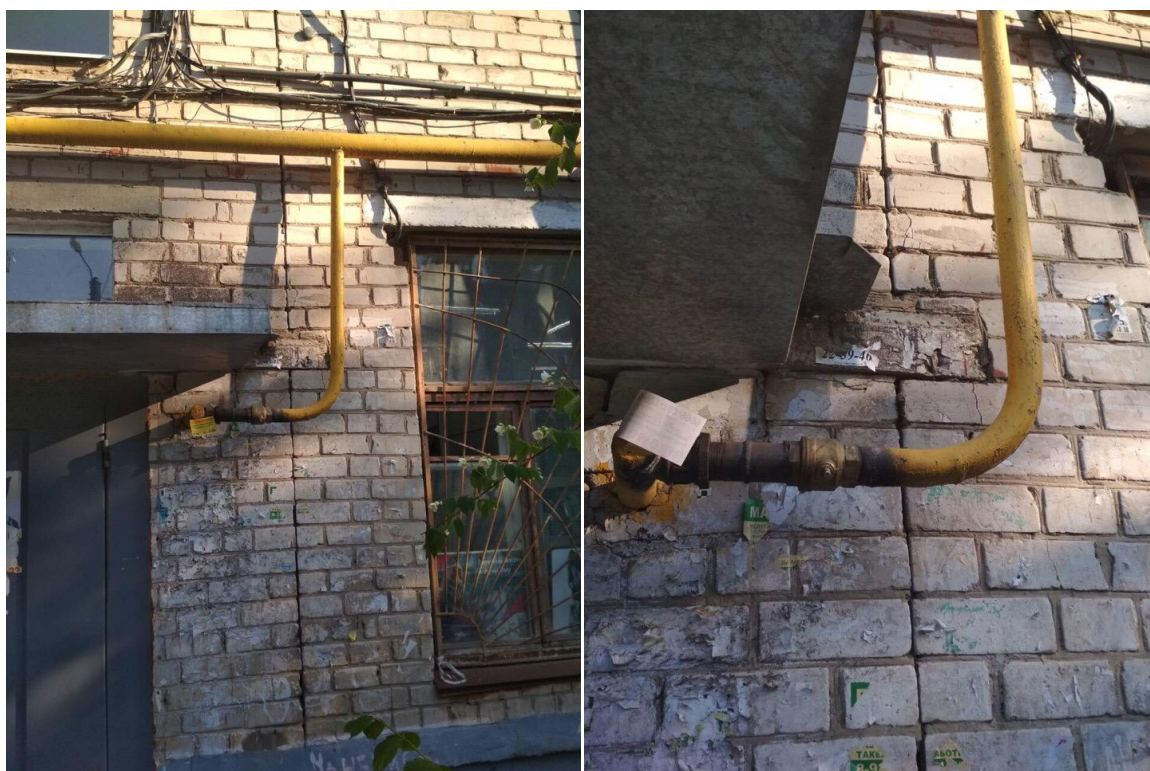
Трещина в наружной стене в месте перевязки температурно-усадочного шва опорным участком железобетонного козырька (г.Тольятти, ул. Мира, дом 68)
